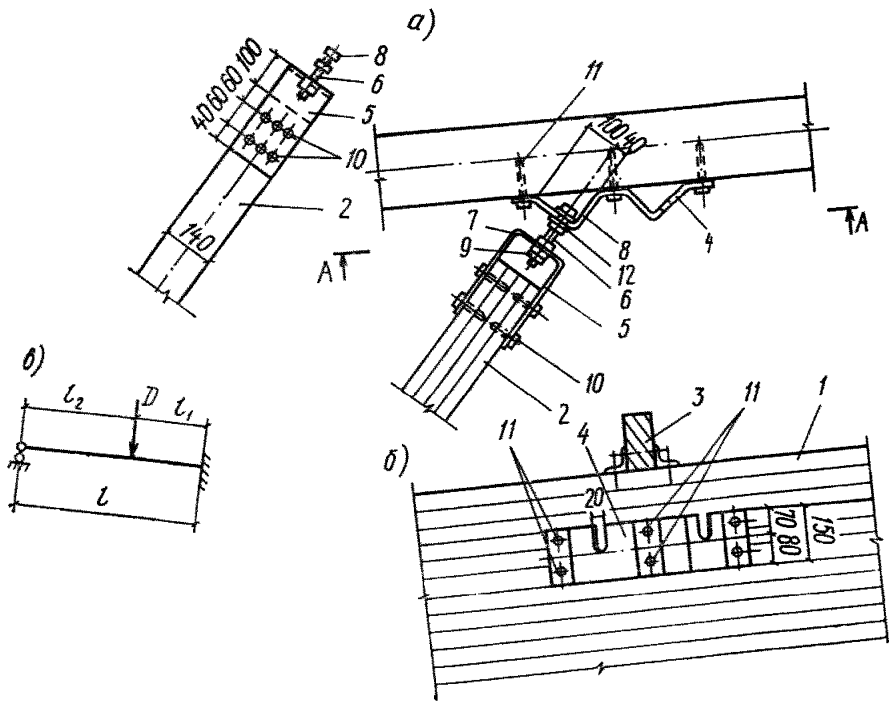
Узлы *А* крепления раскосов связевых ферм
